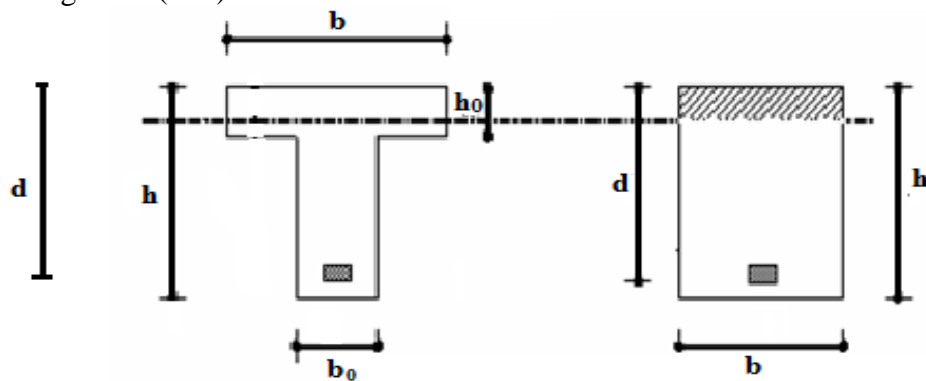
Section rectangulaire et section en «Té» en travée.
